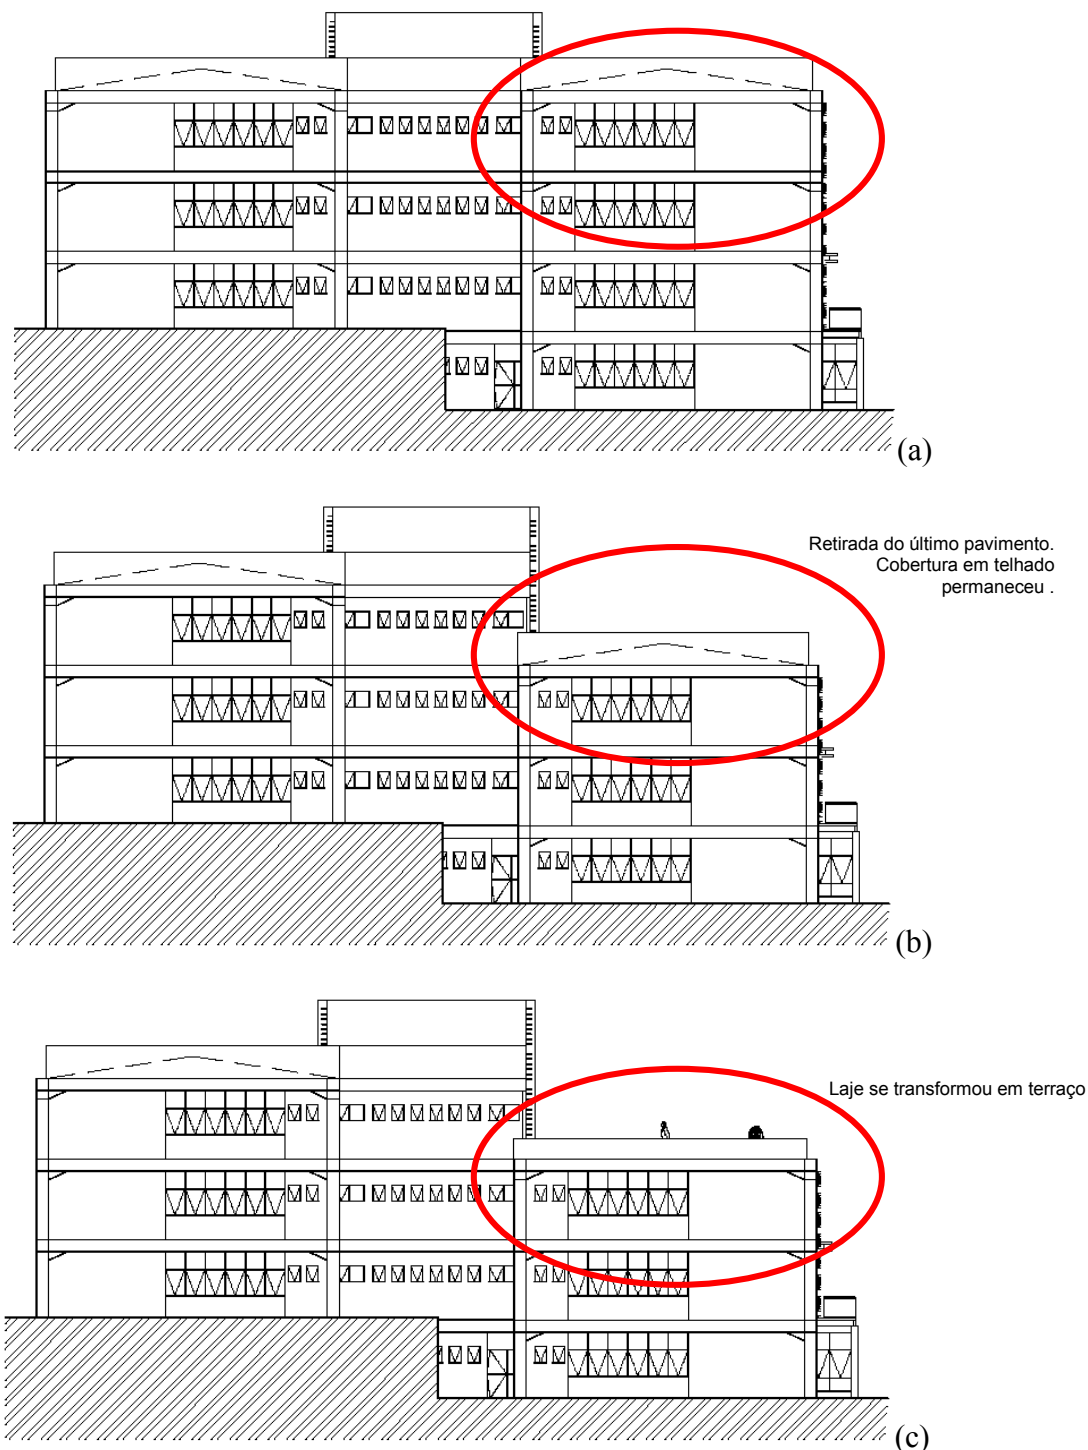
Modificação da volumetria da edificação devido à mudanças nos requisitos de projeto. (a) Projeto inicial; (b) 1ª modificação, antes da fabricação da estrutura metálica; (c) 2ª modificação, após a concretagem das lajes (Fonte: adaptado do projeto EC-A)
